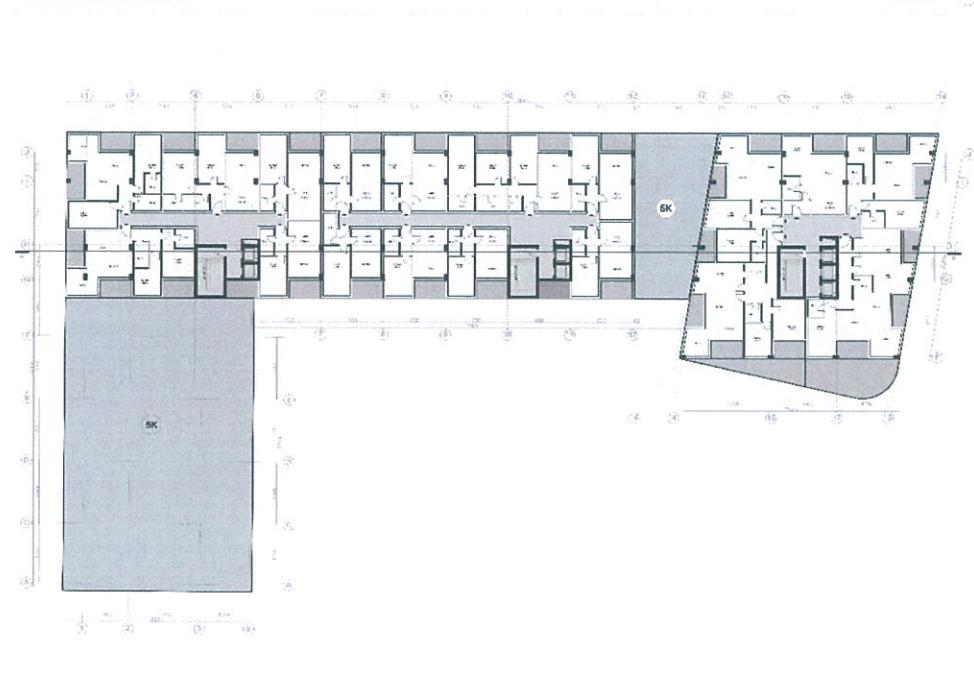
Planimetria në Kuotën +22.75 deri +40.25
